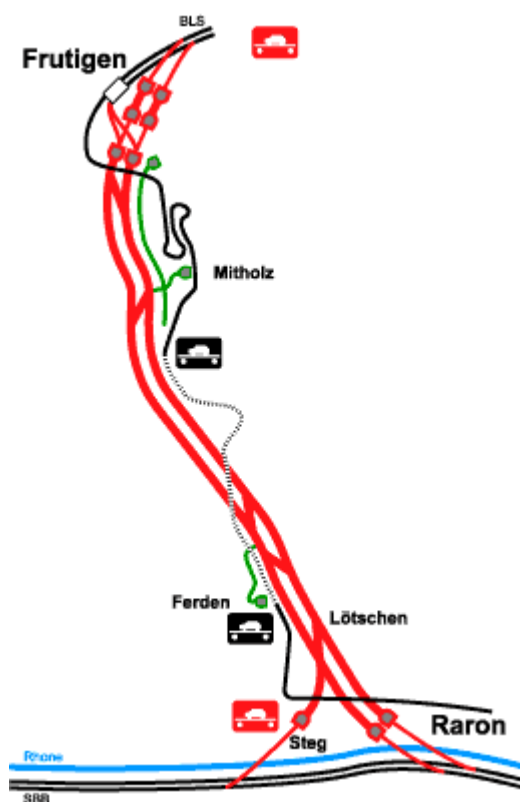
Rete RTE-T – Tunnel del Lötschberg – terza fase
